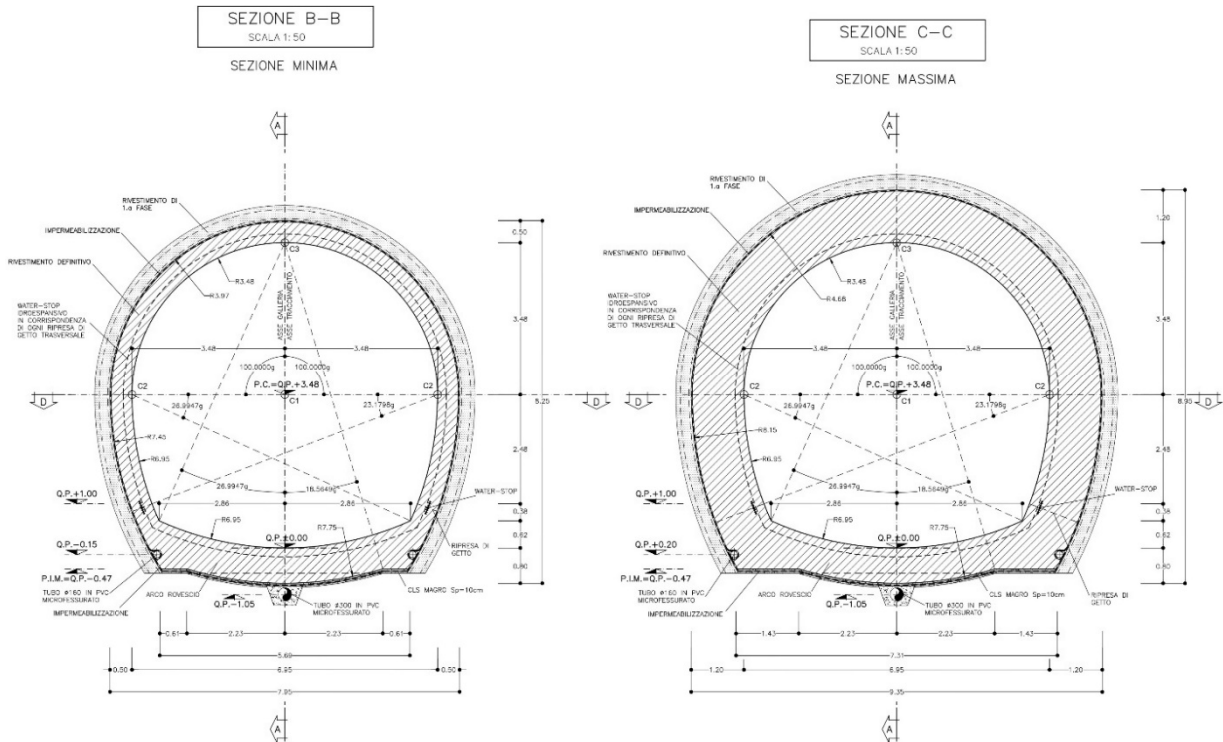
Sezione Tipo B2V\* – Carpenteria – Sezioni
